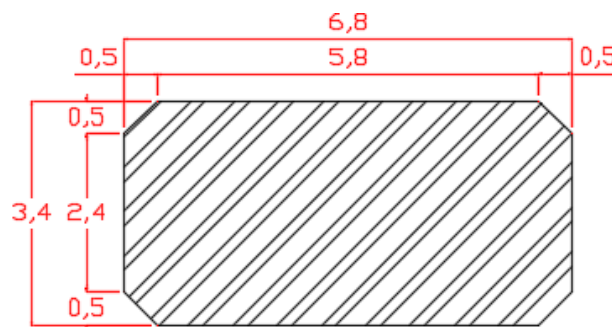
Coupe transversale de la pile du pont(sommier d'appuis) .
